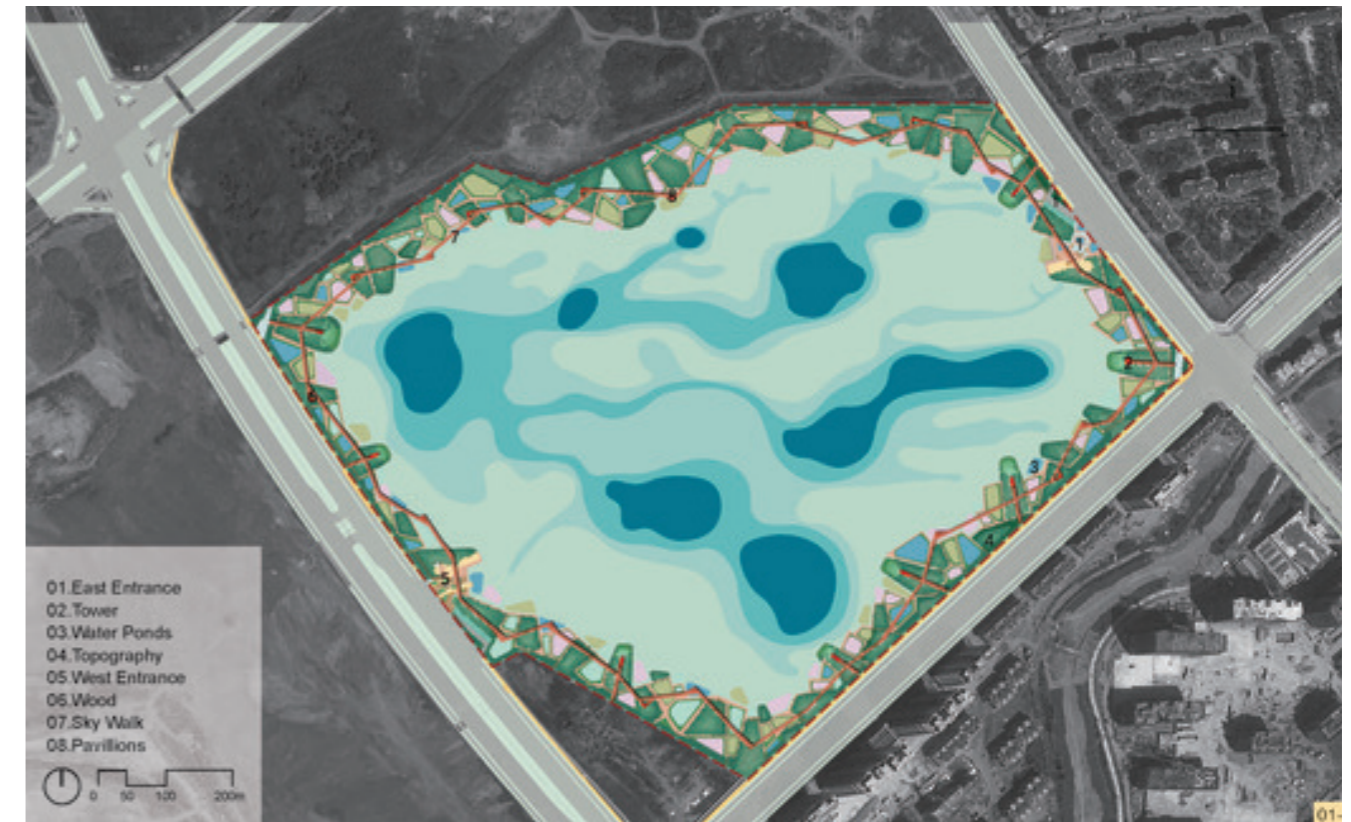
Planta general proyecto. Fuente: ArchDaily
